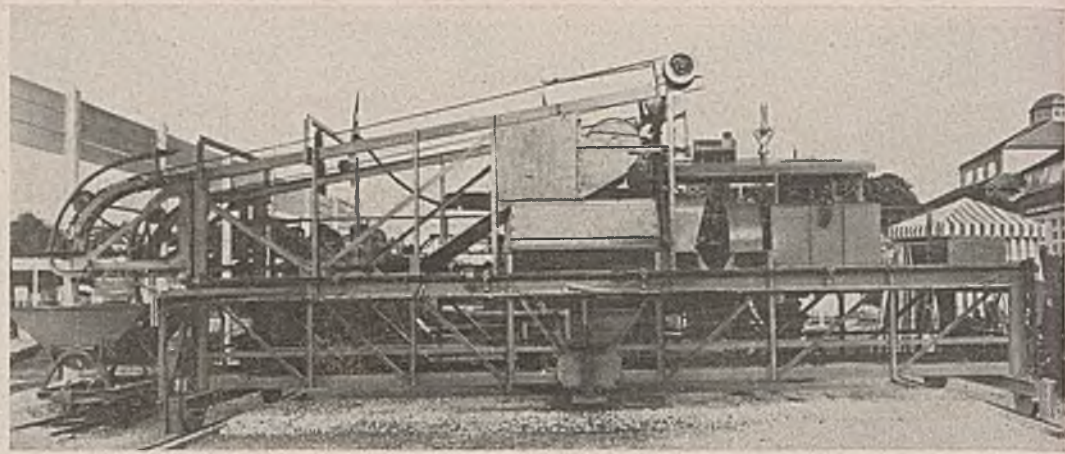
Brückenmischer mit Verteileinrichtung für Betondecken (Sonthofen).
